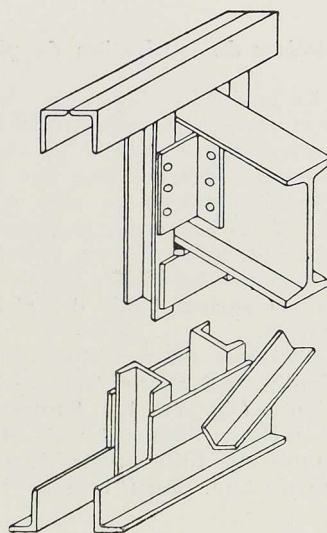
Éléments de poutres partiellement assemblés par soudure.
